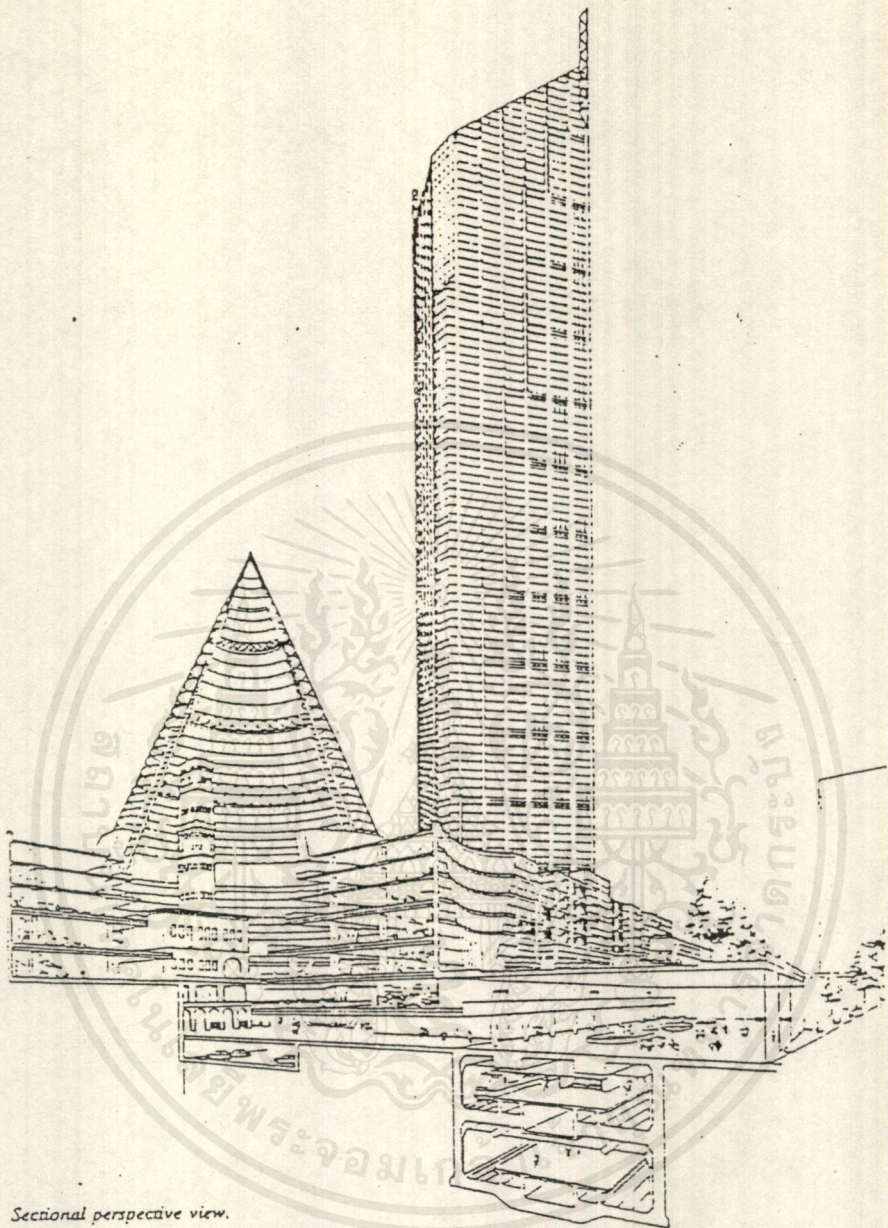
แสดง AXONOMETRIC DRAWING
